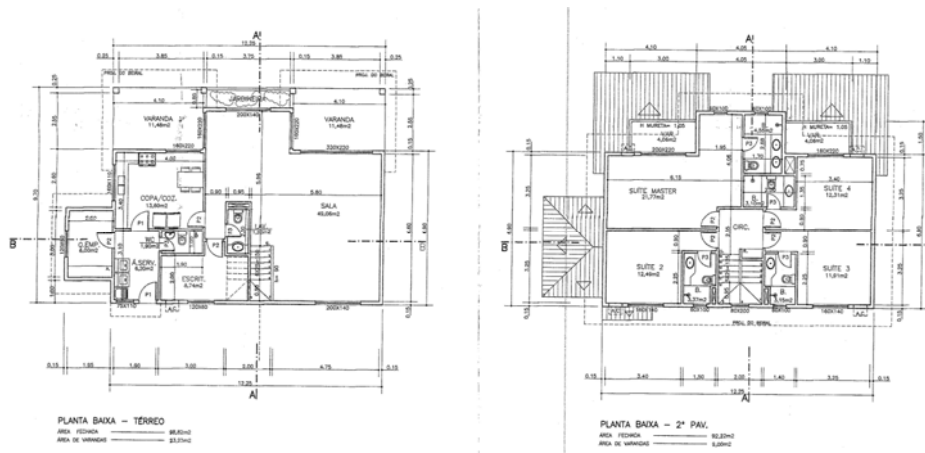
Destaque das plantas do 1º e 2º pavimentos – modificação de projeto aprovado na SMU
